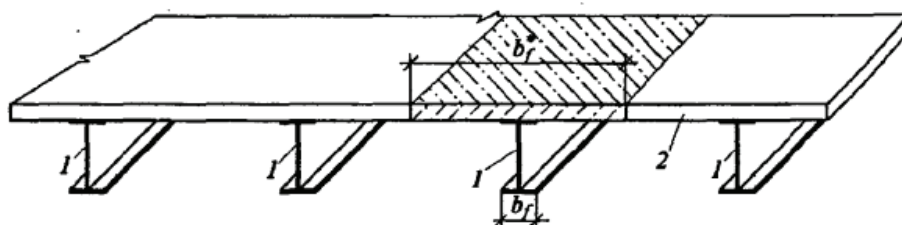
Фрагмент объединенной комбинированной конструкции (двутавр № 30; 2 — бетонная плита, толщ. 10 см.)
